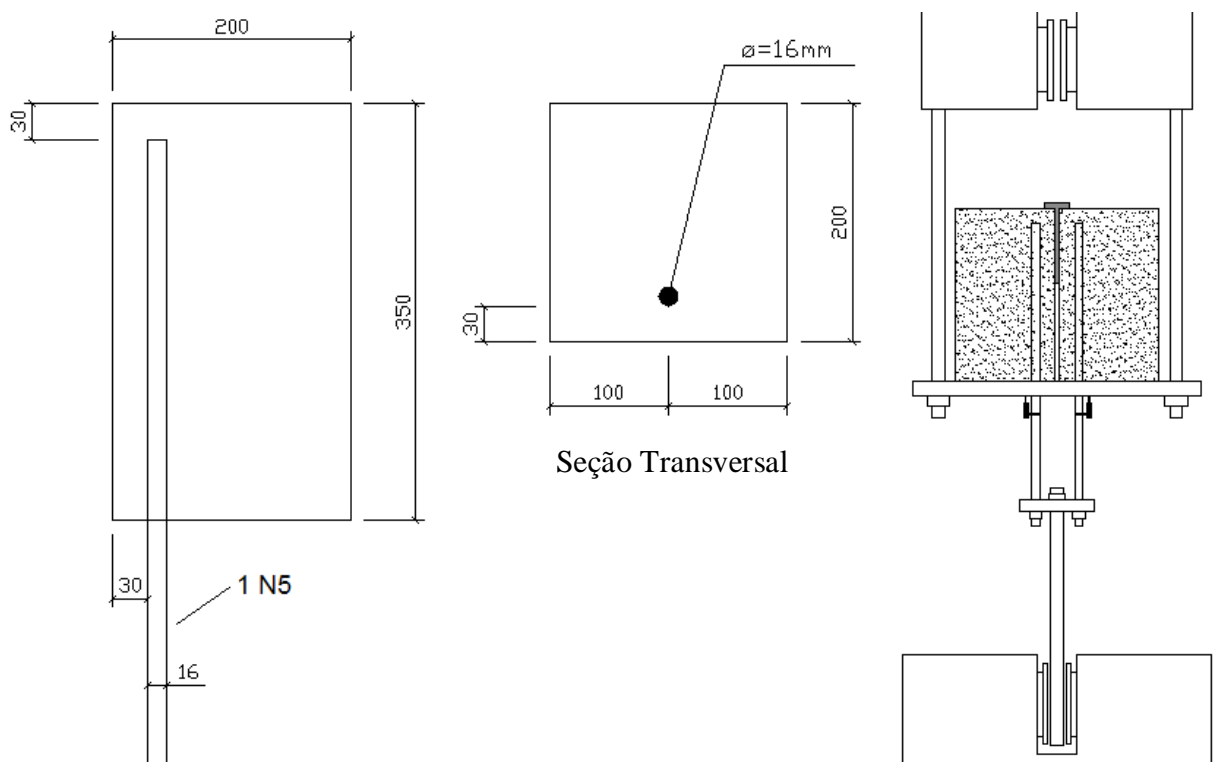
Formas do modelo de arrancamento com barras retas de 16 mm (dimensões em mm)
